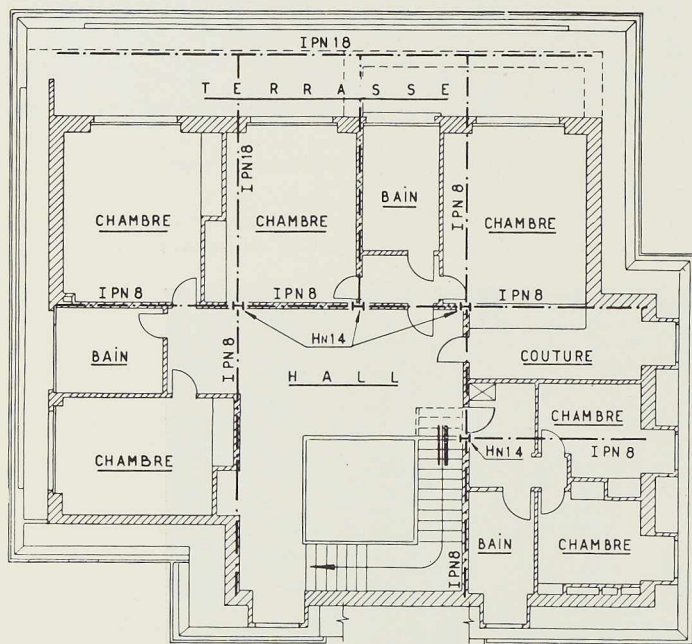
Plan de la villa située au Pinheiro Manso à Estoril.
